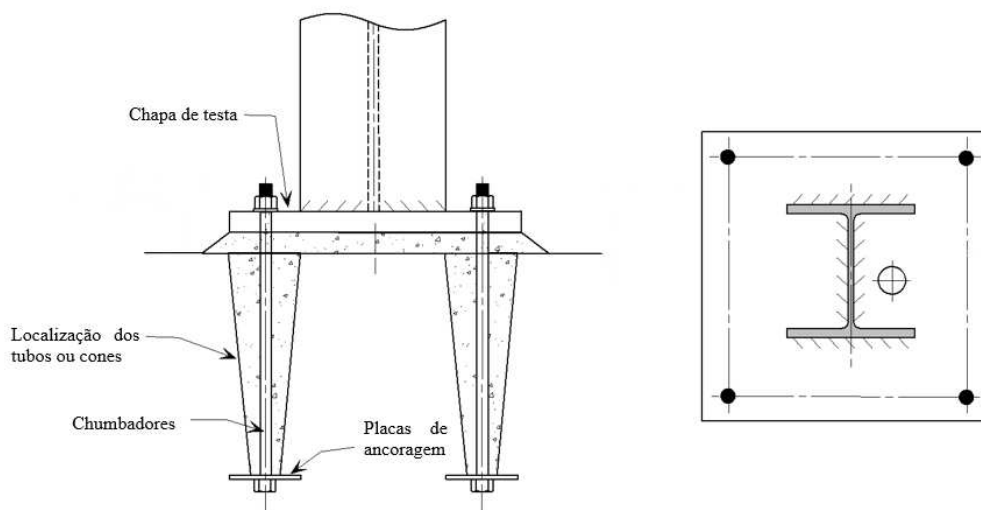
Ligação típica de um pilar à fundação (adaptado de [21]).
